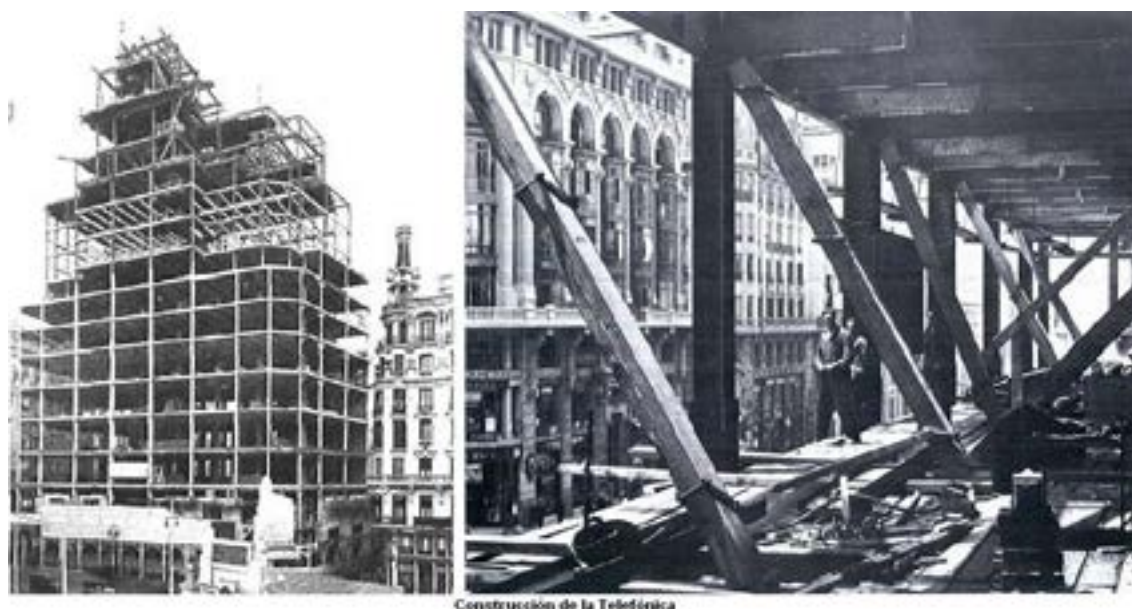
Vista general de la estructura y detalle de apuntalamiento y apeo de las jácenas principales.
